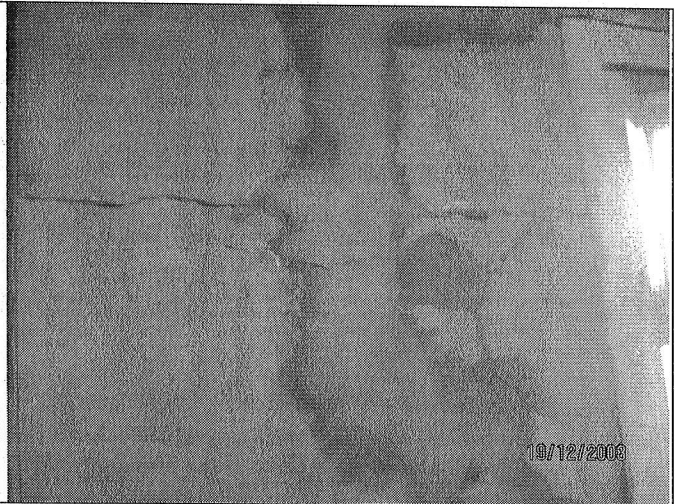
Fisura en muro, presentada en el costado sur, del lote 13 de la manzana 5, con un ancho de 2mm aproximadamente (De acuerdo a la Figura 1)
